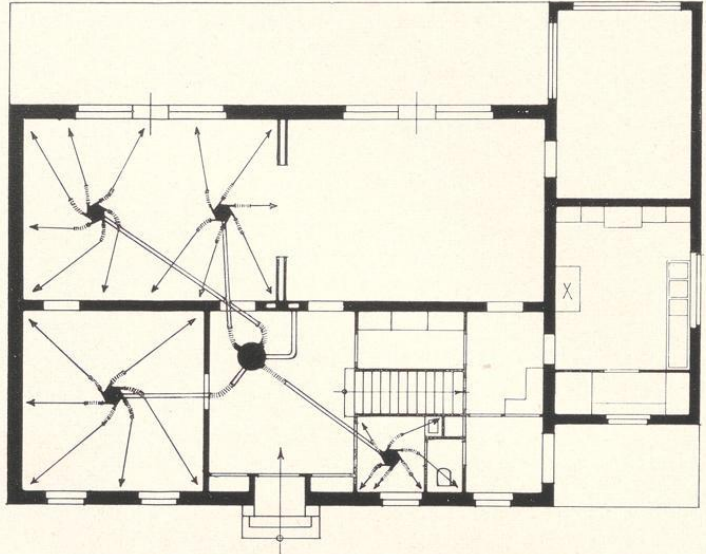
Föhngebläse-Bauaustrockner in der Anwendung, rechts der Heizofen mit Frischluftzuleitung, links das Gebläse mit den Gebläserohren. — Bild 191. Grundriß eines Einfamilienhauses mit den eingezeichneten Aufstellungsorten des Föhngebläses
